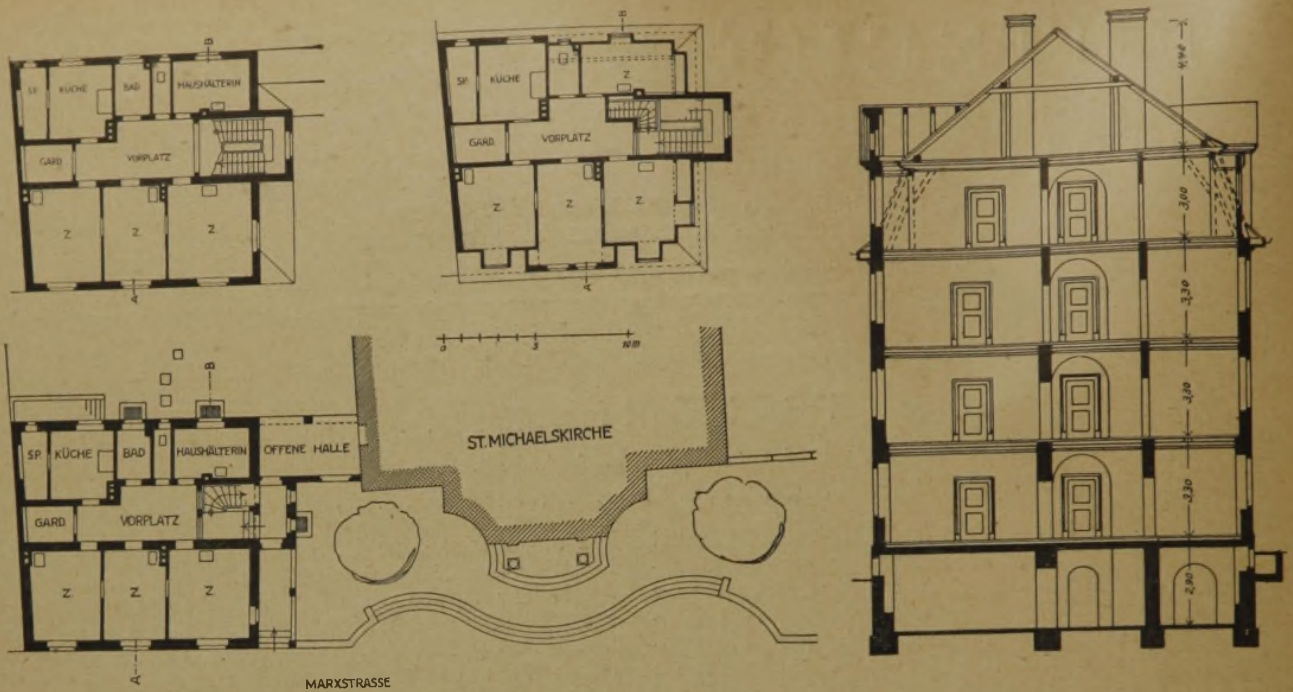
30 (hierüber.) Grundrisse des Erd-, Ober- und Dachgeschosses (1 : 400) und Schnitt (1 : 250) vom Pfarrhaus St. Michael zu Nürnberg.
